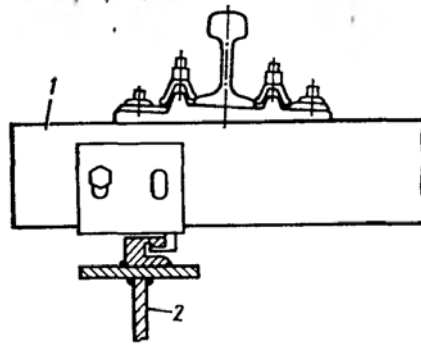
Узел соединения мостового бруса (1) с продольной балкой (2), допускающий их взаимные перемещения
